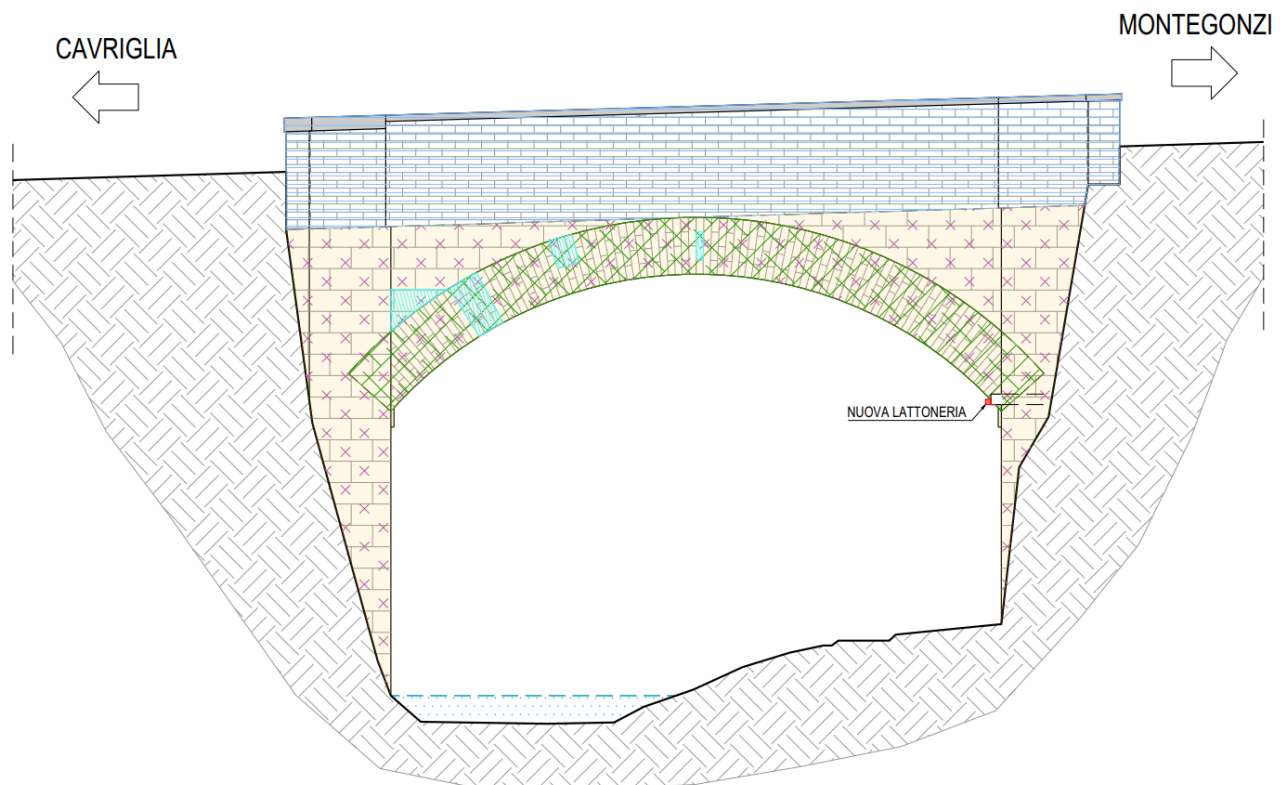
Stato di Progetto - Interventi di consolidamento - Prospetto ovest
